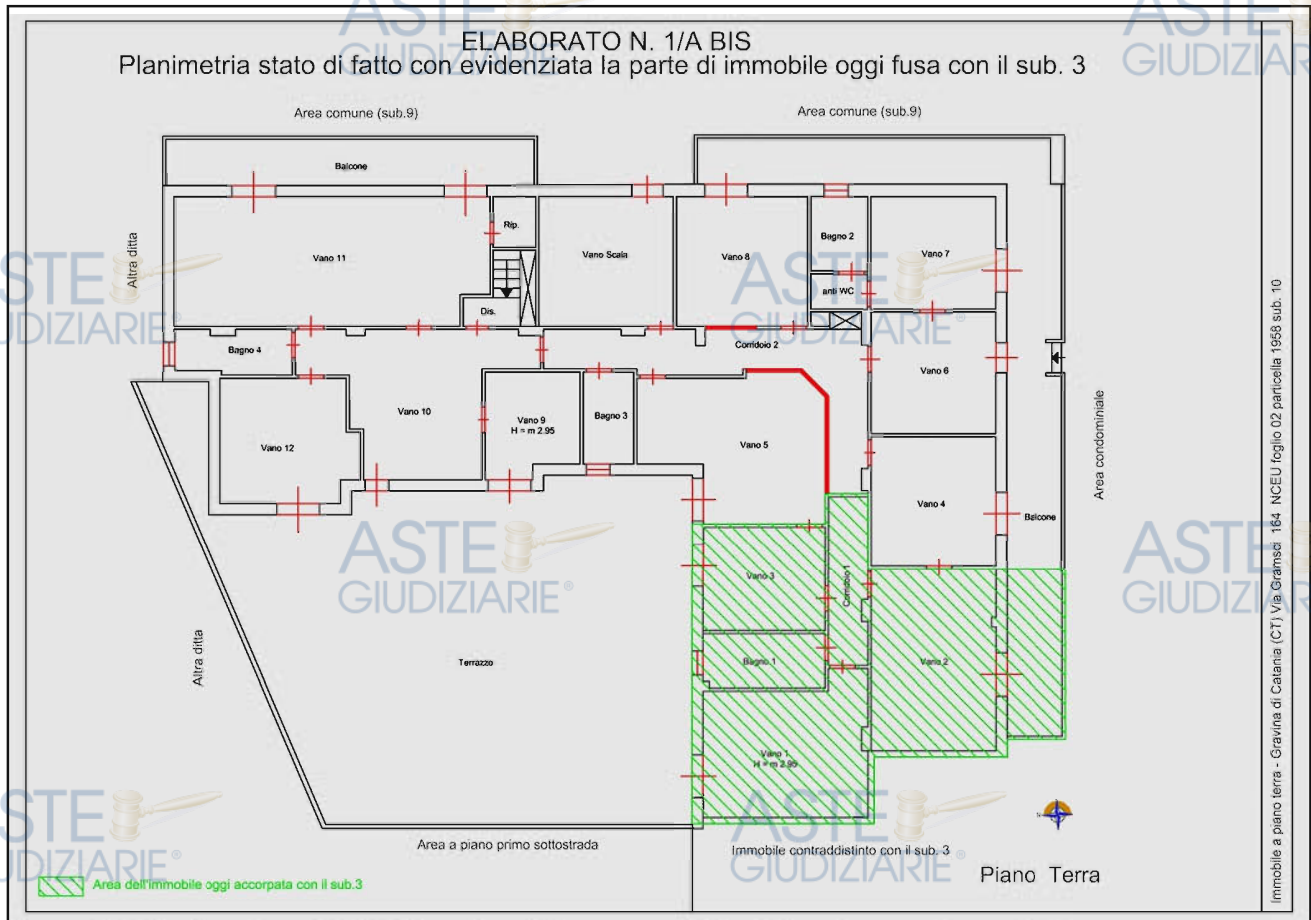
Visualizzazione della planimetria raffigurante oggi i luoghi, con la parte in verde che attualmente risulta accorpata con il sub. 3 (immobile adiacente)
